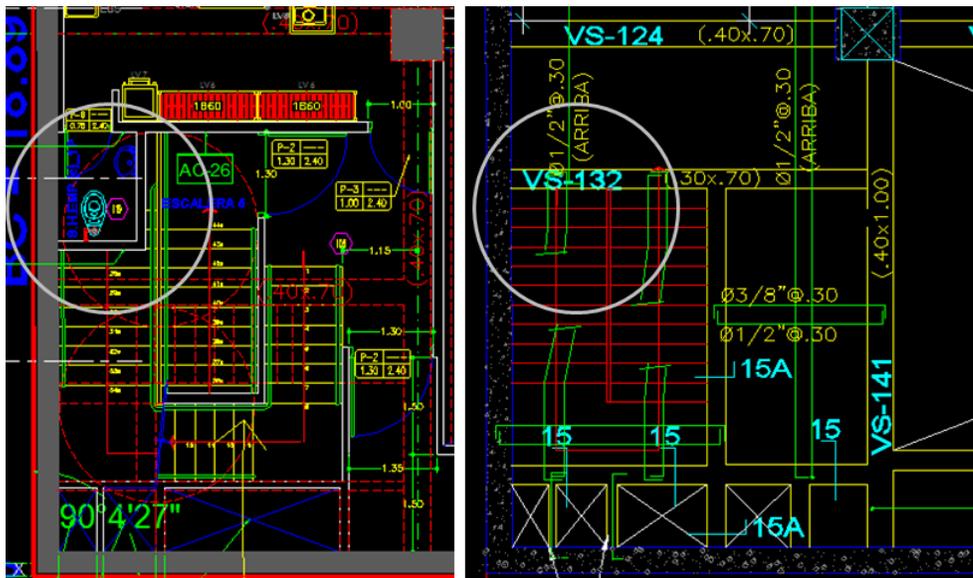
(Izquierda) Losa del SS.HH. según el plano de arquitectura.
